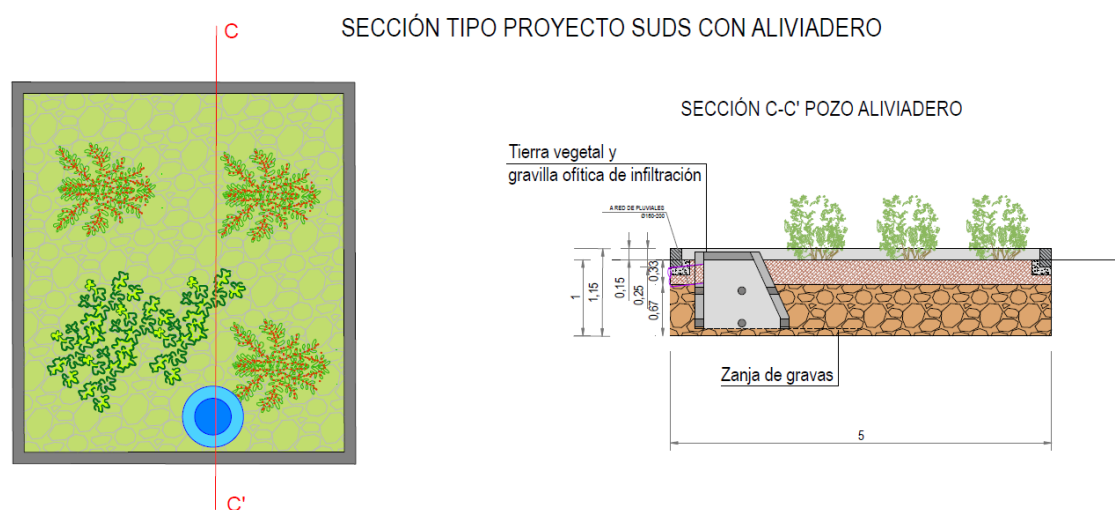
Sección tipo de parterre con pozo filtrante de alivio.
